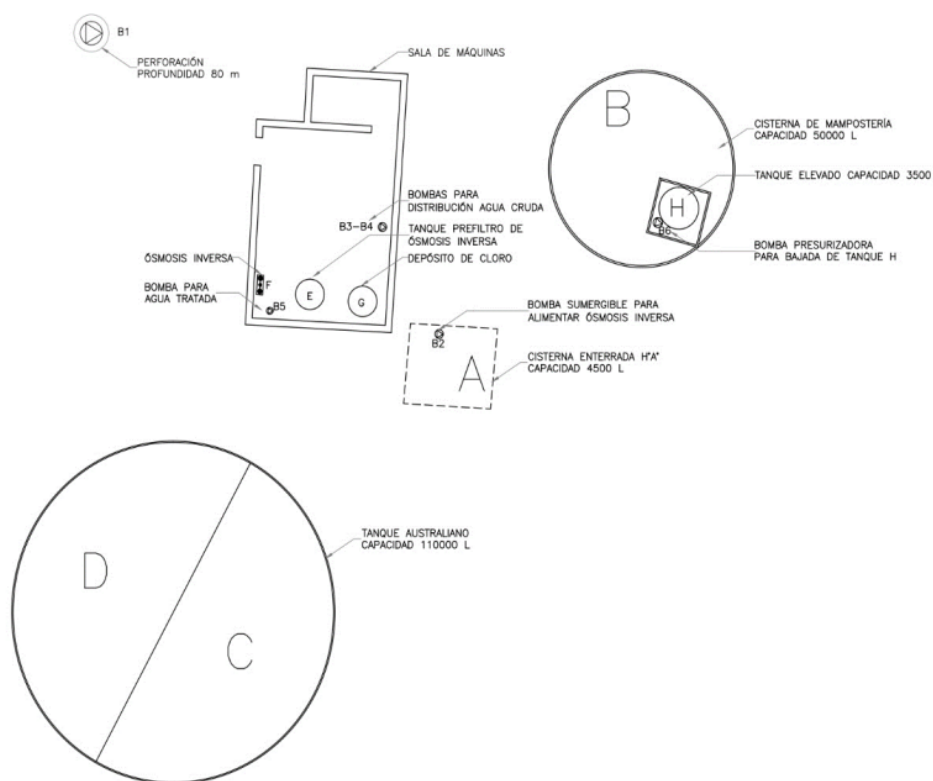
Plano de Equipamiento de Planta (Fuente: Propia)
